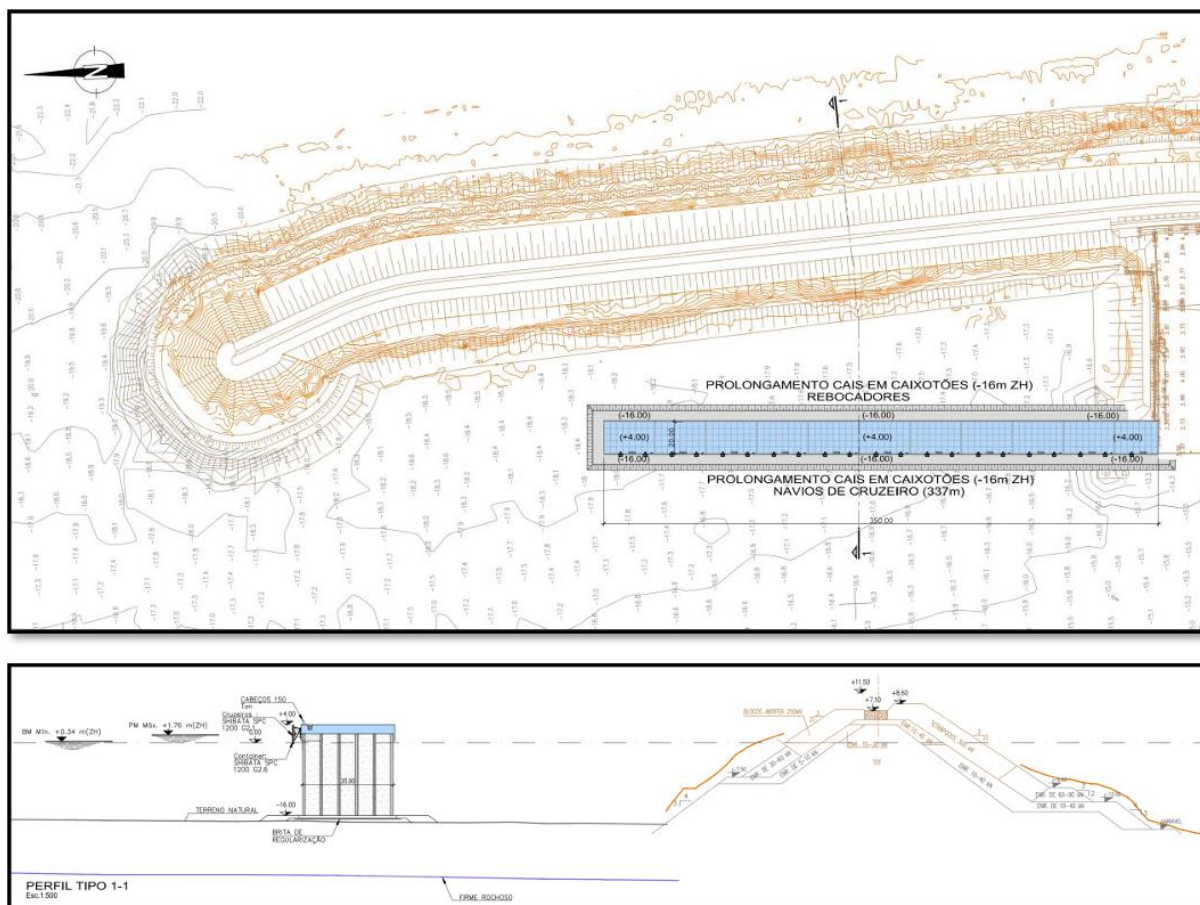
Prolongamento do cais existente à -12m (ZH) – SOLUÇÃO 2 (planta e perfil tipo) (Desenho obtido do Estudo Prévio).
